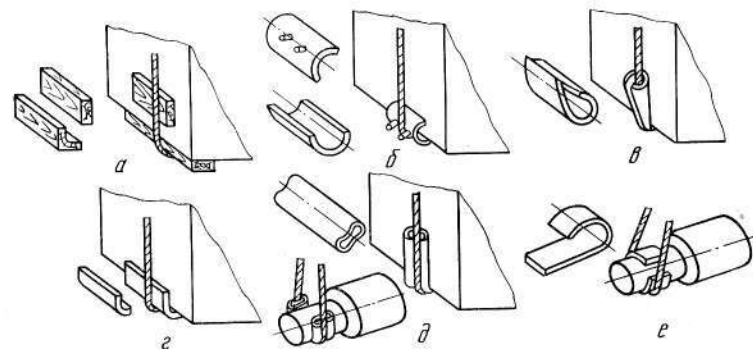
Установка предохранительных подкладок под стропы при увязке узлов оборудования;
